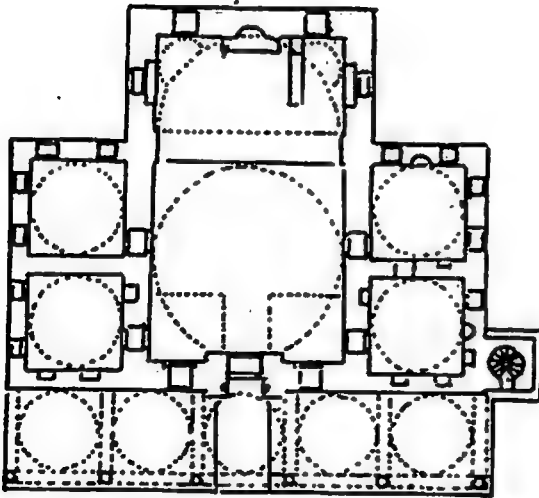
المسقط الأفقي لجامع ططر خان في كوزلوا .
